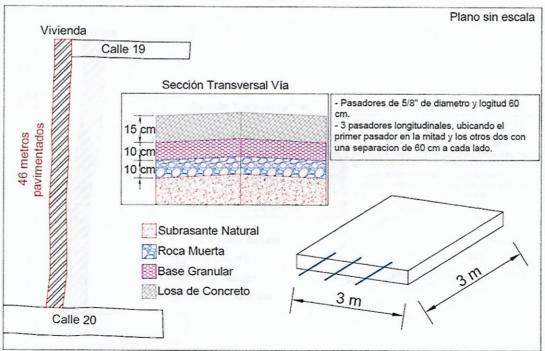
Plano y sección transversal calle 20A entre carreras 12 y 12A
